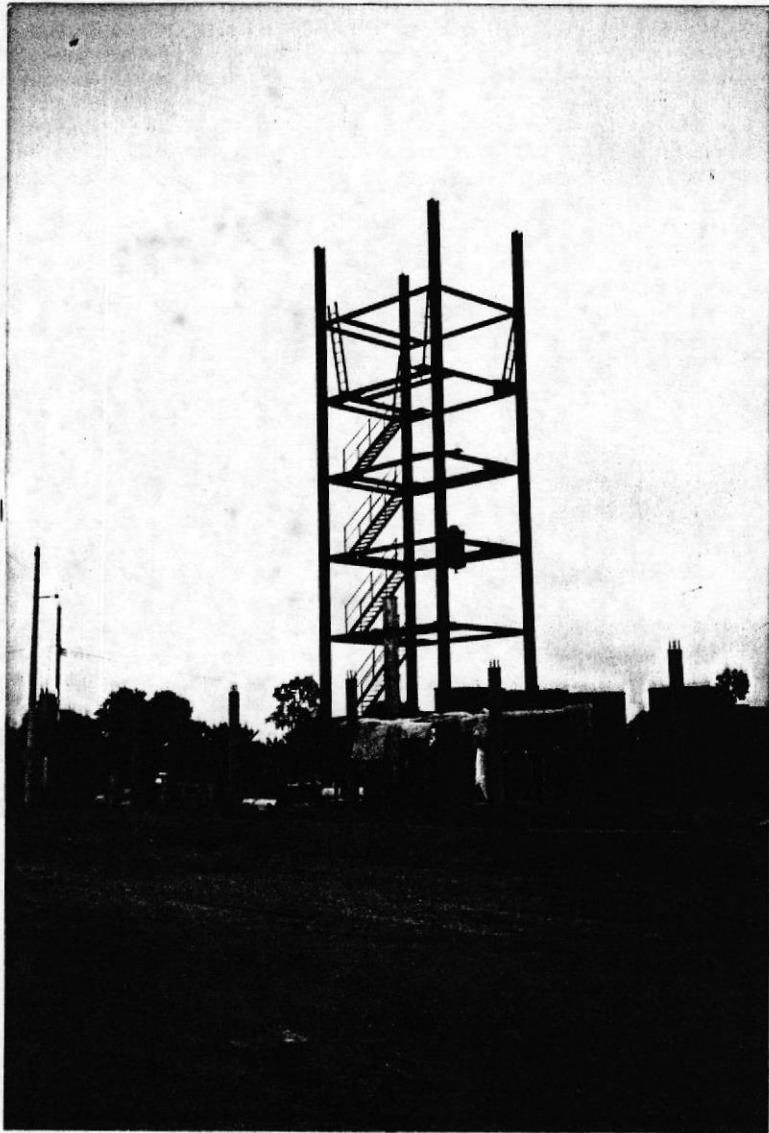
ESTRUCTURA DE LA PLANTA.
